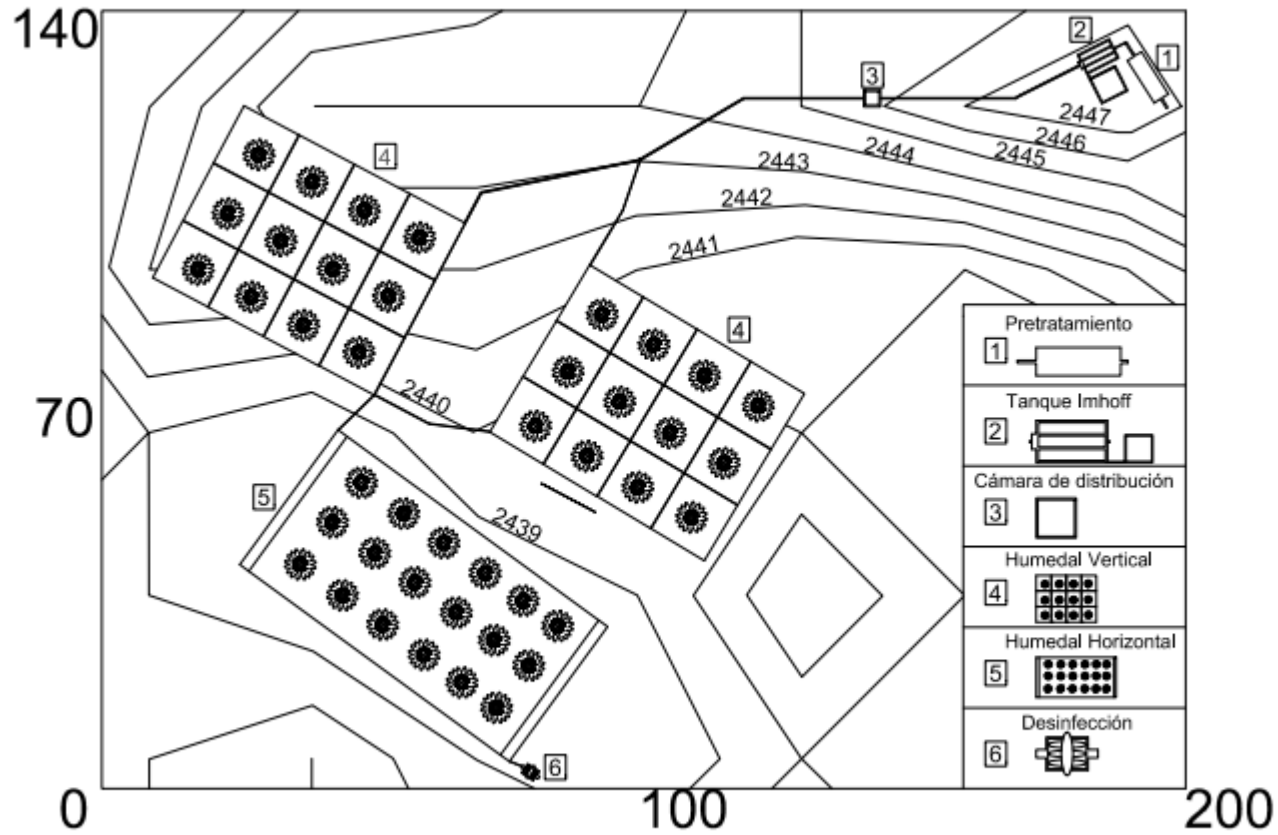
Disposición de elementos en escala para planta de tratamiento propuesta.
